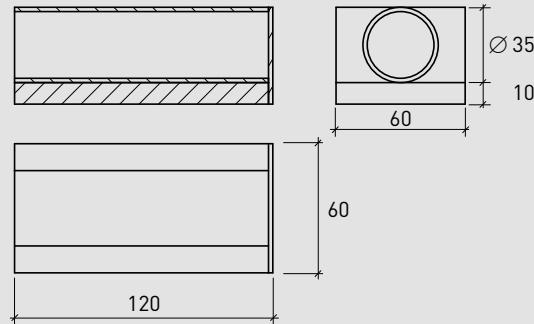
Abmessungen MVK für Einbau in Mauerwerk
